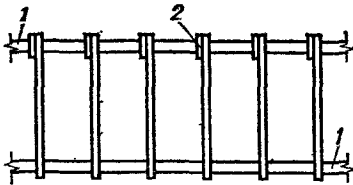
Арматурный каркас, образованный из гнутых хомутов и продольных стержней с вязкой всех пересечений:
